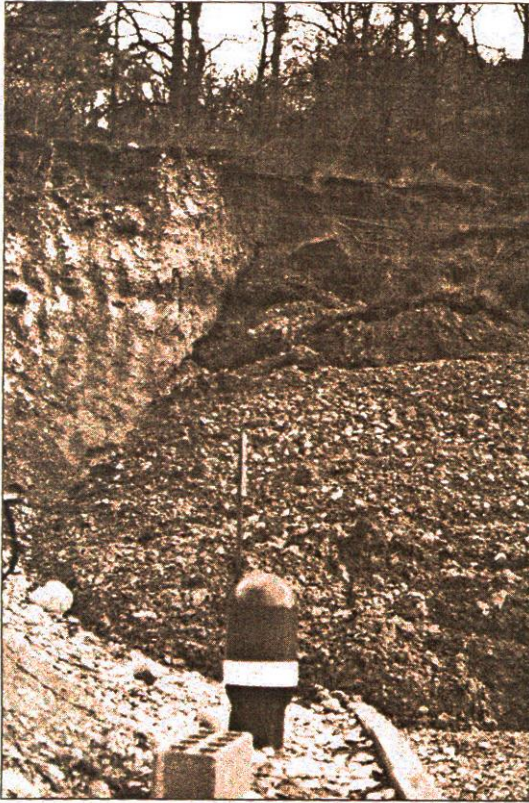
Paroi clouée – Mise en place des barres d'ancrage
